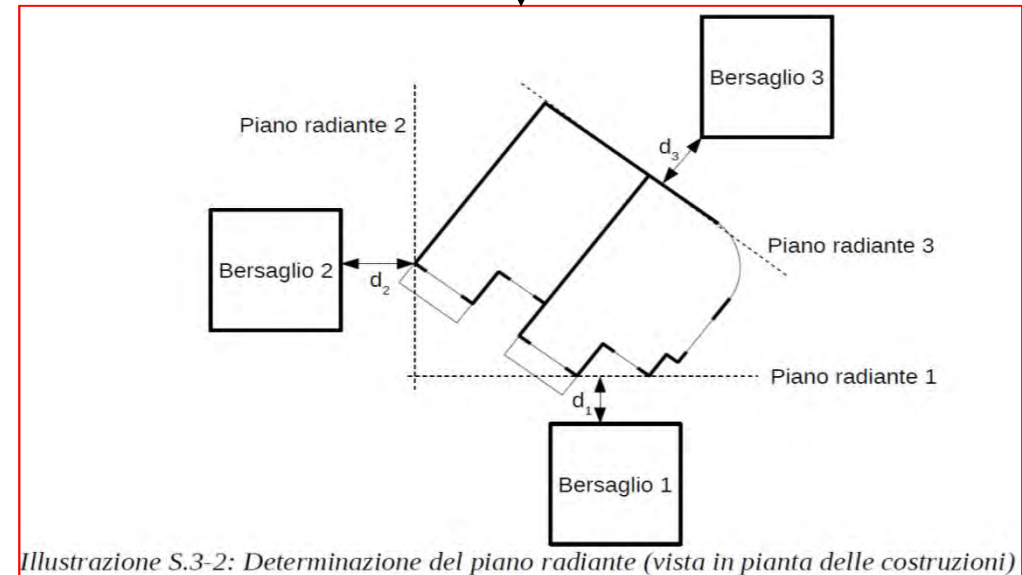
Determinazione del piano radiante (vista in pianta delle costruzioni)
